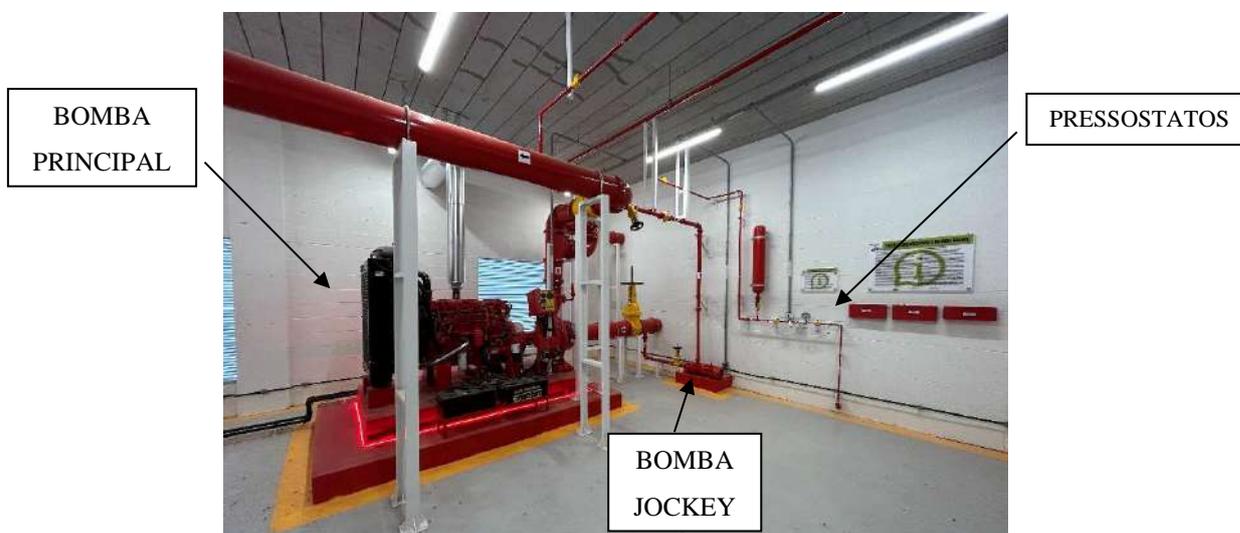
Exemplo de instalação de bomba principal e bomba jockey de um sistema de combate a incêndio (Fonte: Autora)
